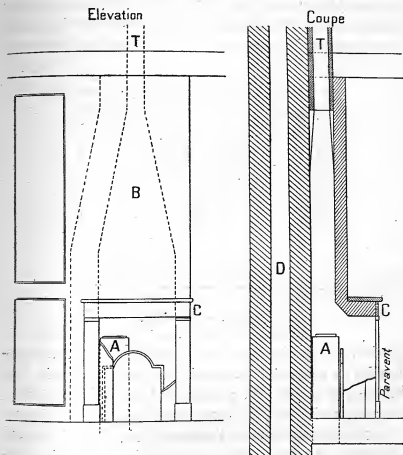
Plan en élévation et en coupe de la cheminée.
